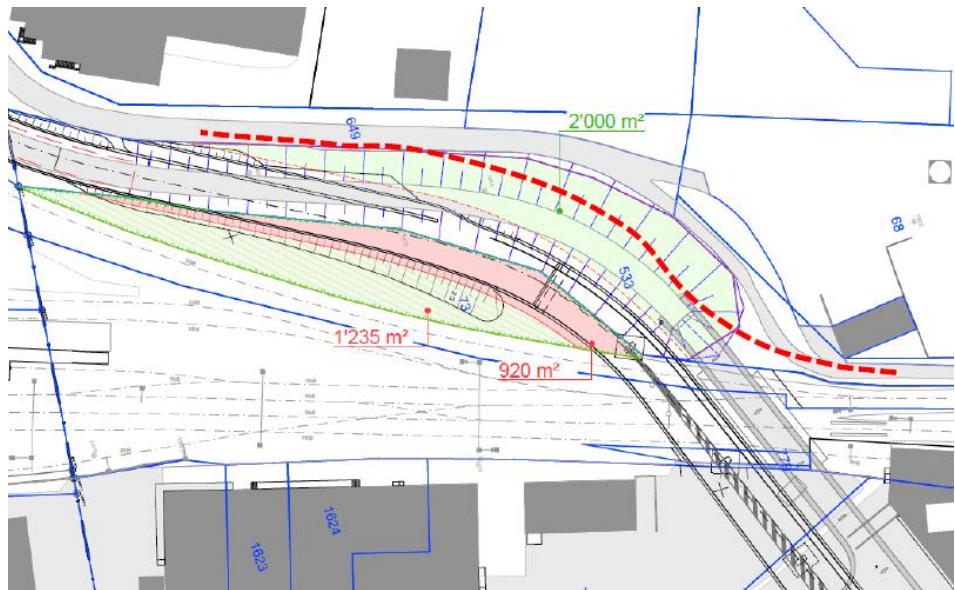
Plananschnitt Ausführungsprojekt Querverbindung Untervaz–Zizers, Rodung; geplante Verschiebung Oberauweg (rot), (ASTRA, Jan 2013 / R+K, April 2022)
